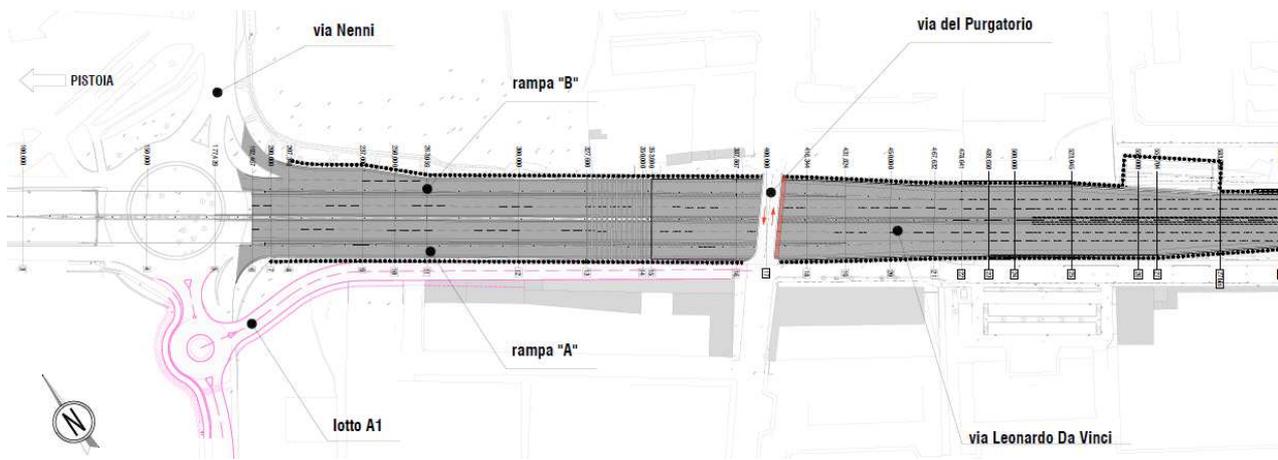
Stralcio planimetrico con individuazione della rampe "A" e "B"
